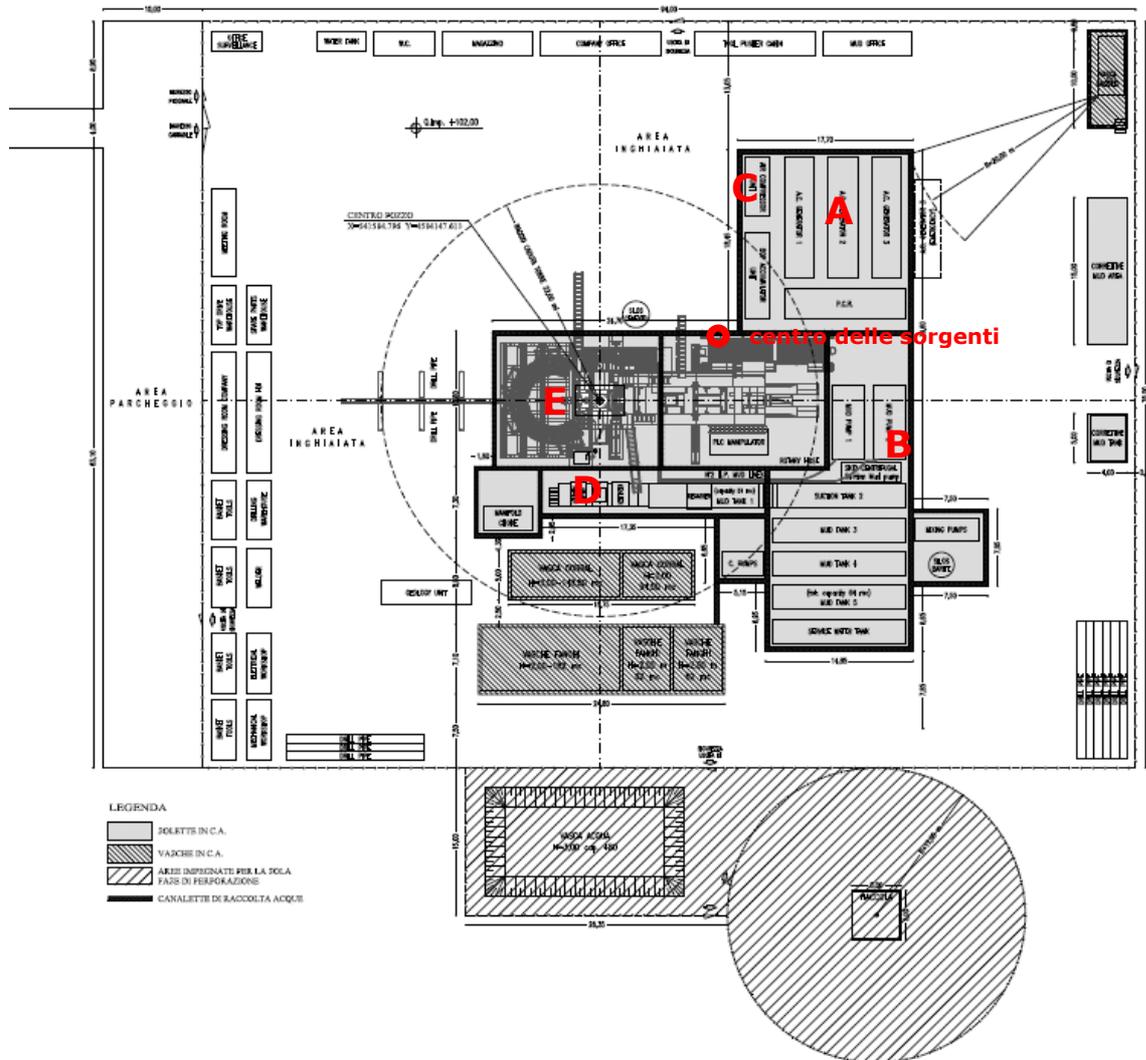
Layout cantiere di perforazione del pozzo Masseria Conca 1 Dir.
